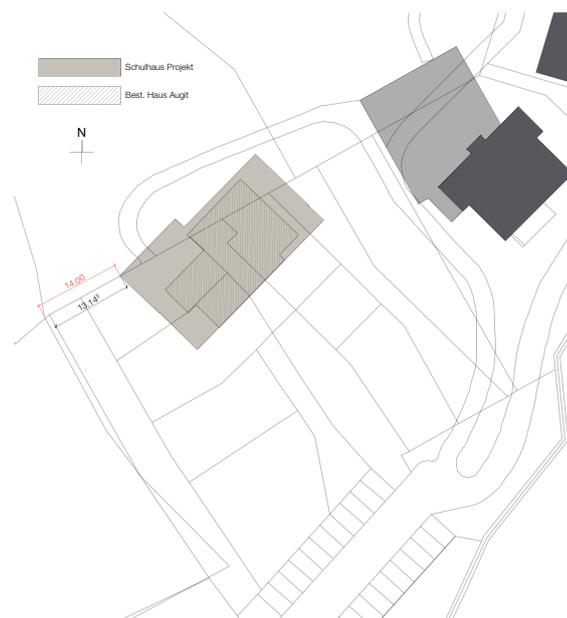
Situation: beige = Projekt, schraffiert und grau = bestehende Gebäude / Einstellhalle
